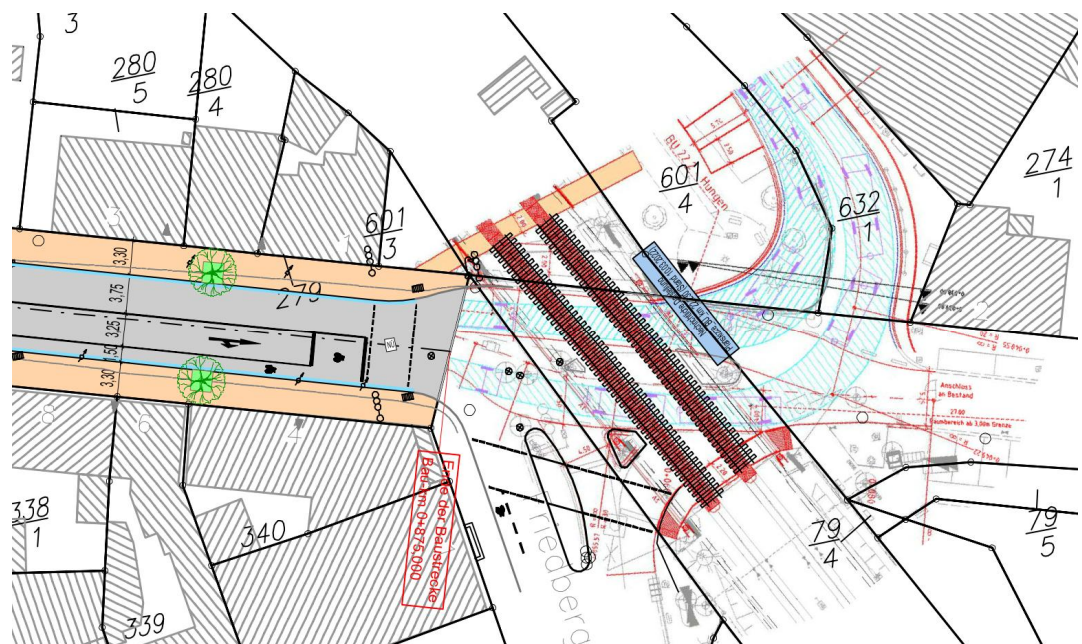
Lageplanauszug Stadt Hungen / Büro IGM [2]
